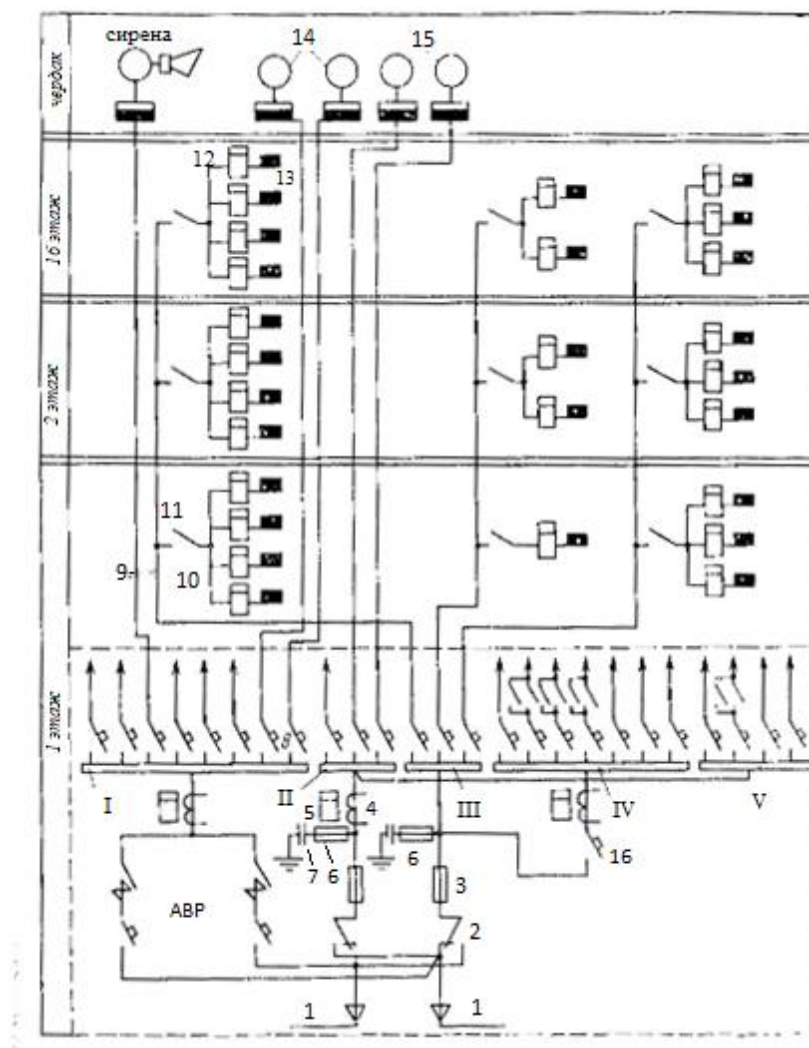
Принципиальная схема электроснабжения 16-этажного I-секционного жилого дома
